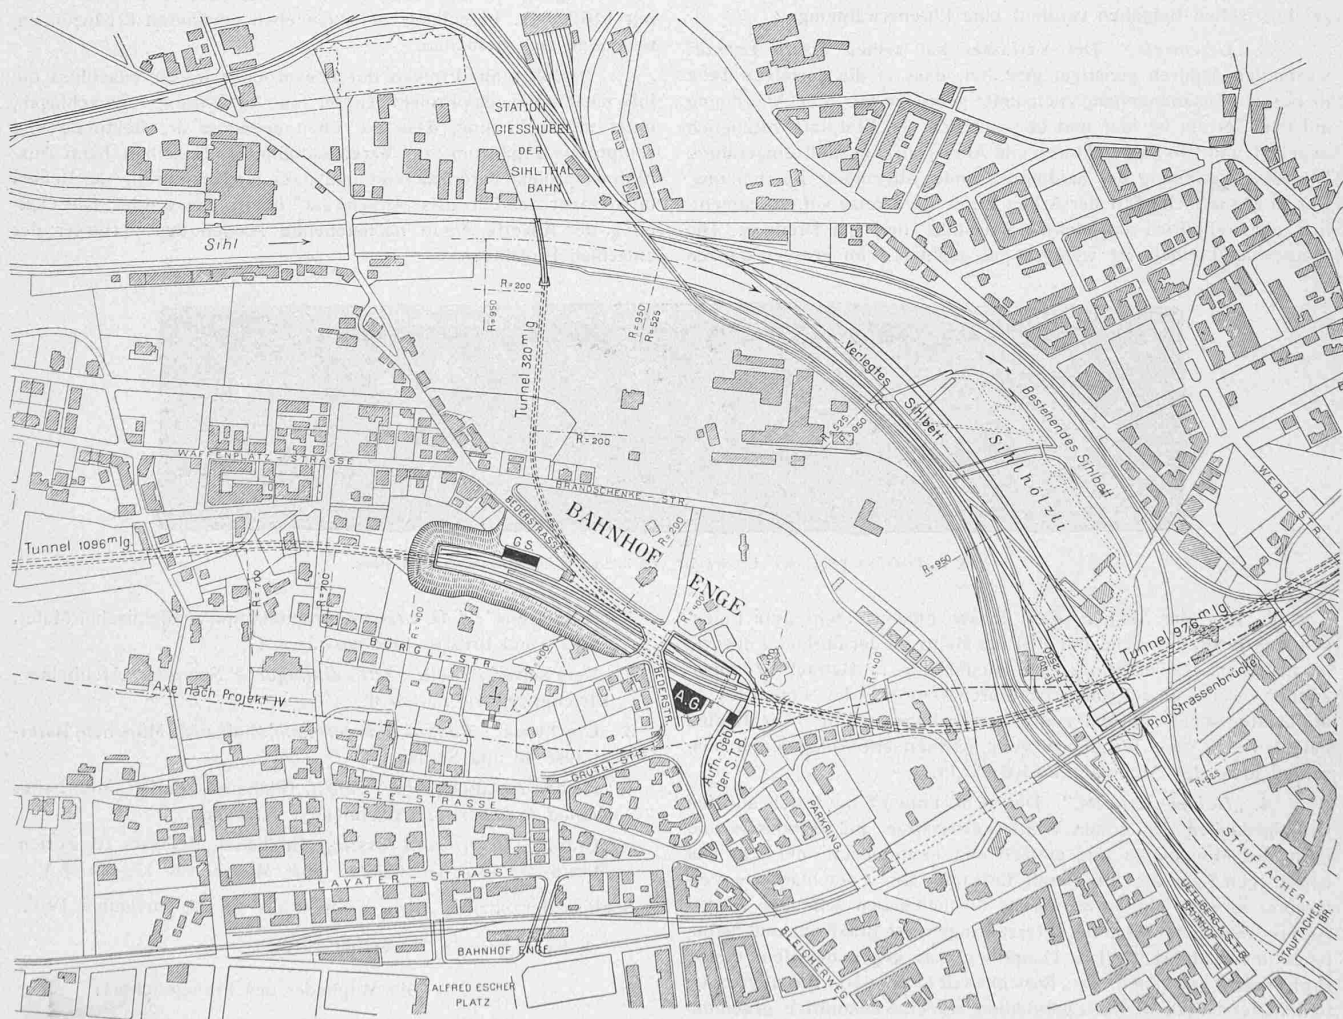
Lageplan von Station Enge und Sihlkorrektur. — Masstab 1:7500.
